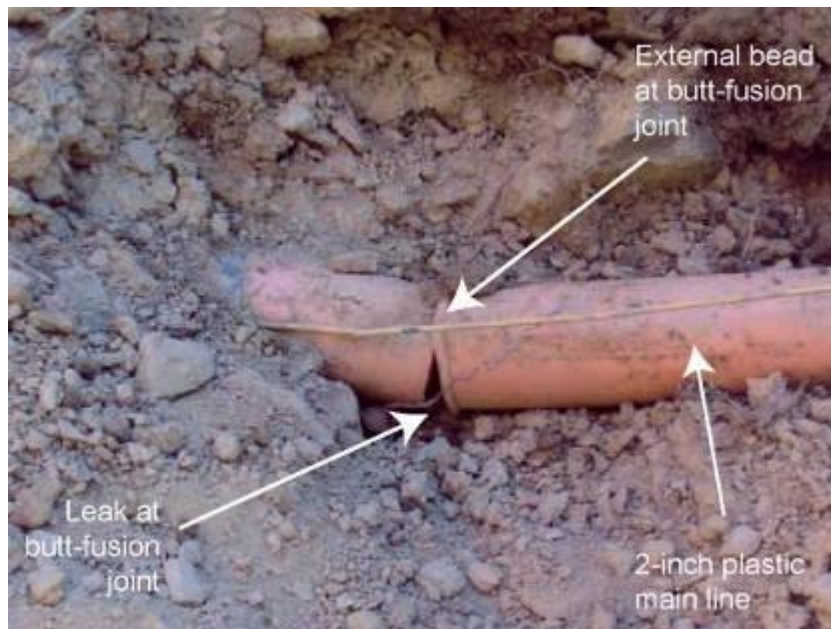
Falla de la junta soldada por la técnica de *Butt Fusion*.
